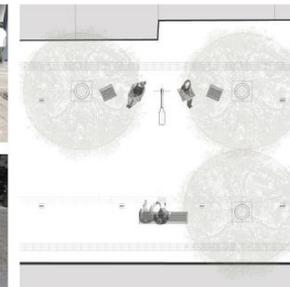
Lupa de la disposición en planta de las bancas en el T3.
